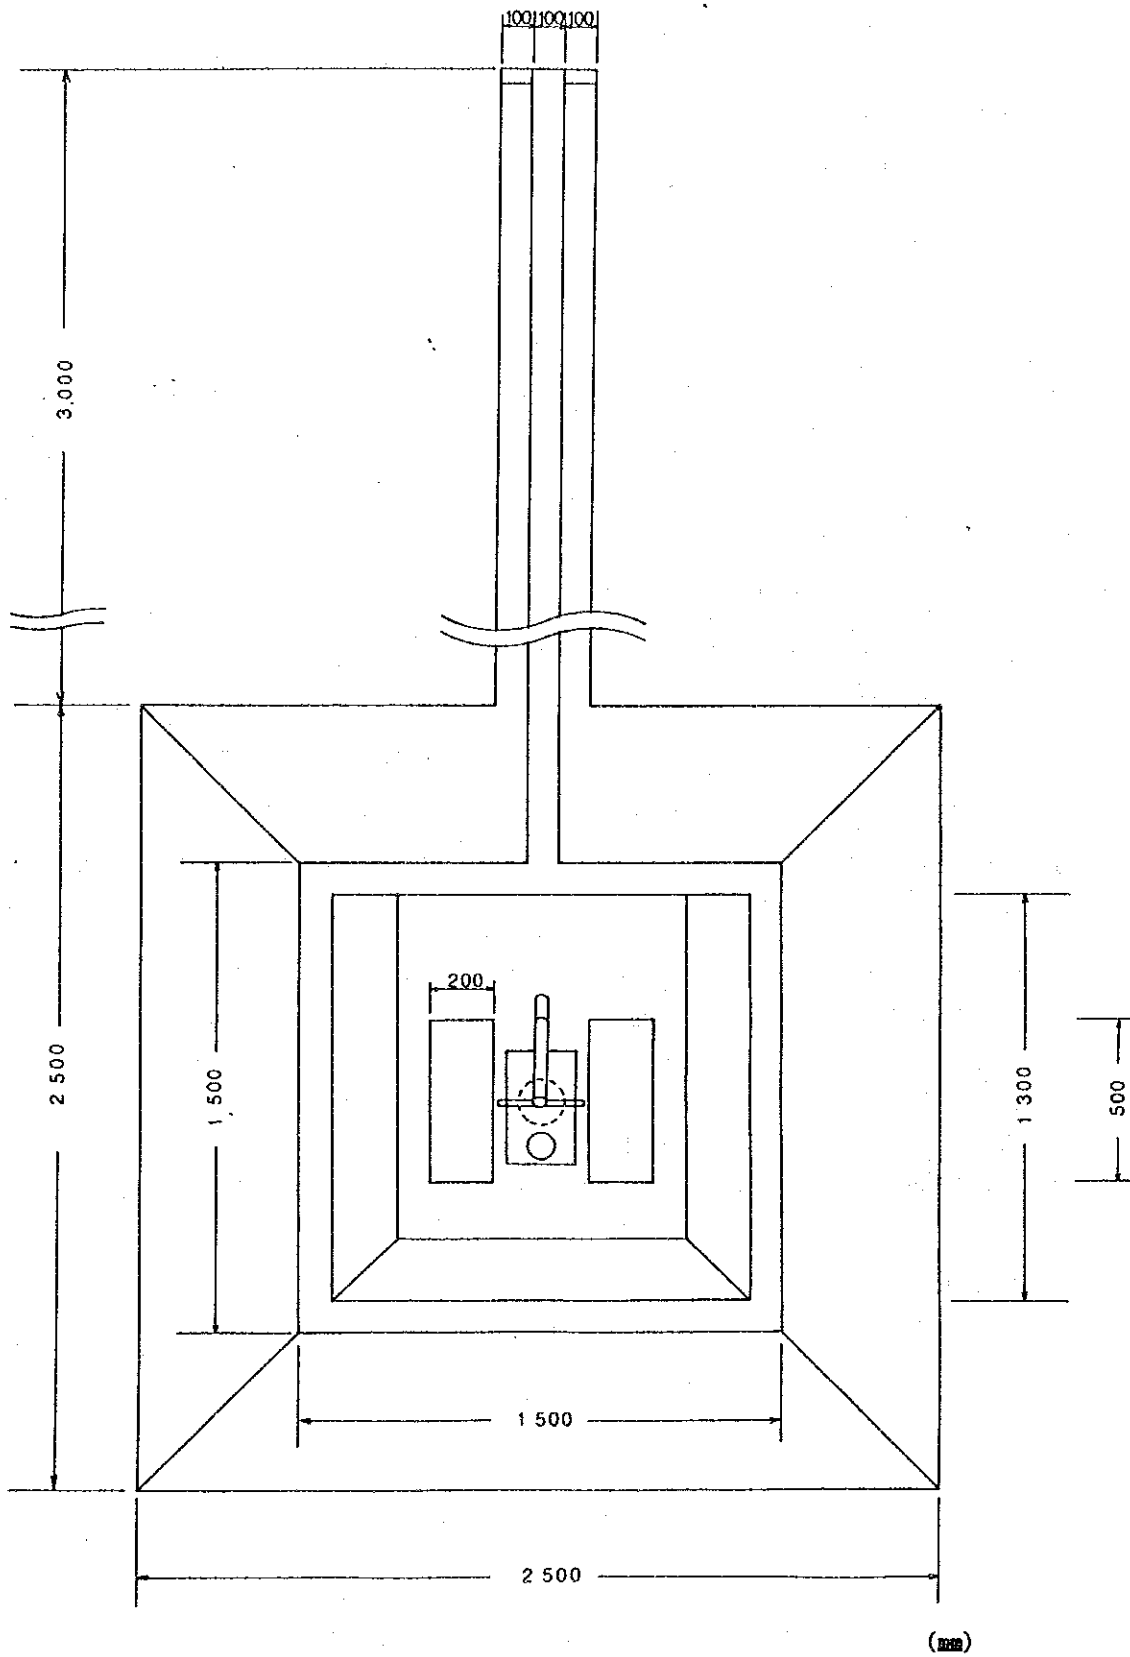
Plan d'un forage et de ses structures annexes
